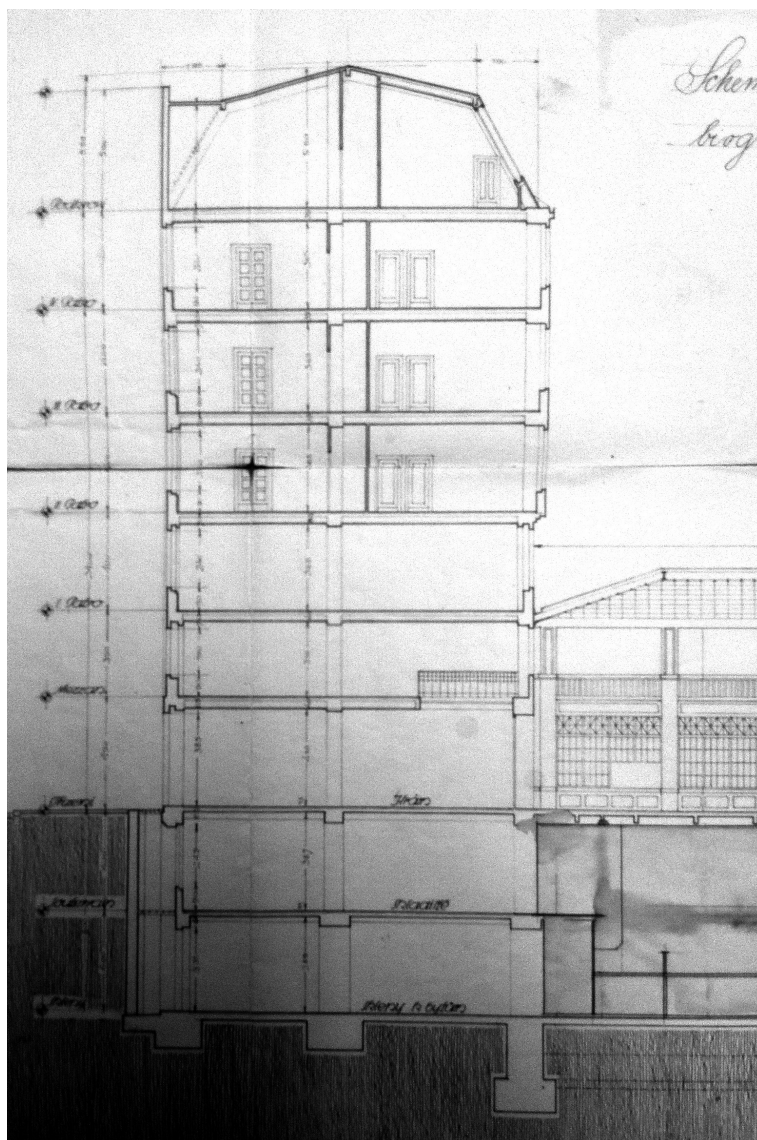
, 3.5.1.30 a 3.5.1.31: Prostor bývalého divadelního sálu byl původně určen pouze pro sklad, dodatečně zde ale vznikl nejdříve zábavní sál, který byl roku 1934 přestavěn na divadlo. Při této přestavbě sem byl vložen zdejší železobetonový balkon. Prostor byl původně prosvětlován čtveřicí sklo-betonových oken ve stropu (viz. šipka), která ústila v úrovni chodníku dvorní části pasáže. Otvary zanikly patrně při adaptaci na divadlo roku 1934. Zdroj: Josef Holeček, Petr Štoncner, Jan Freiburg, *Dílčí stavebne-historický průzkum paláce U Stýblů*, Praha 2010.
